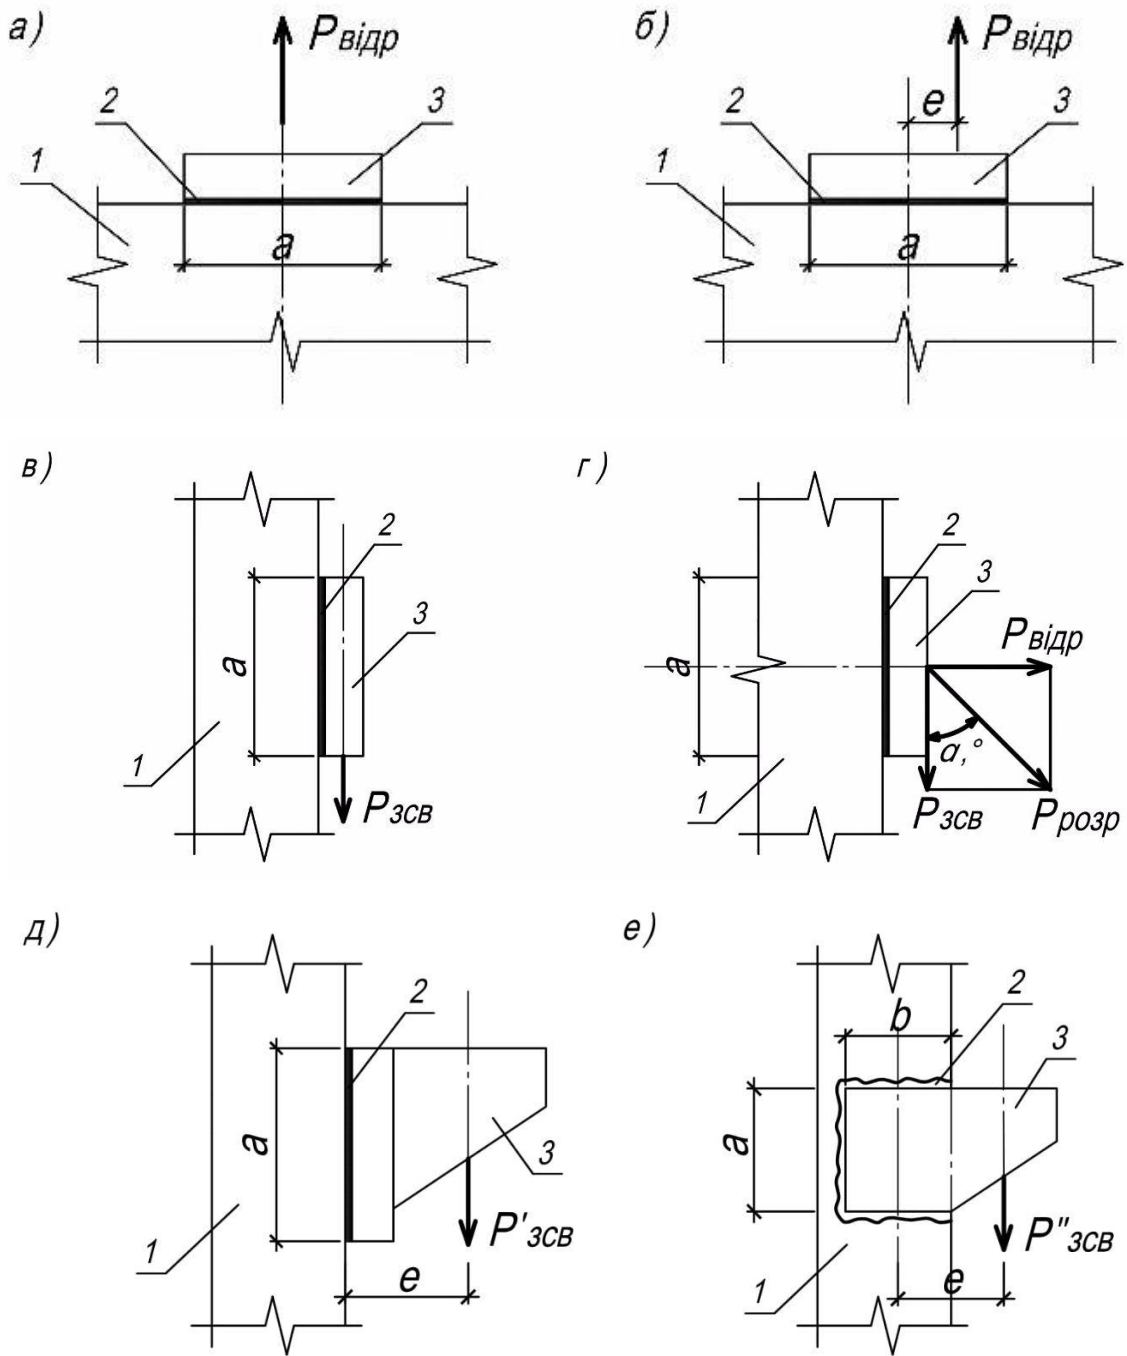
Розрахункові схеми клейових сталобетонних безанкерних з'єднань:
